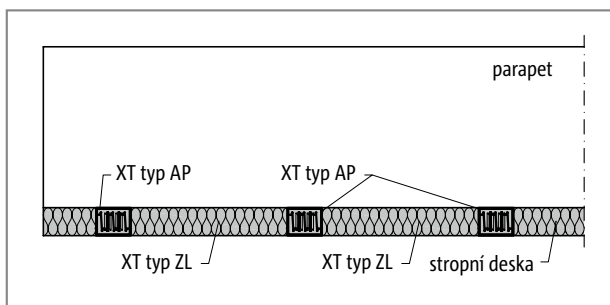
Schöck Isokorb® XT typ AP - svislé zabudování: Půdorys, uložení parapetu resp. atiky na stropní desce
